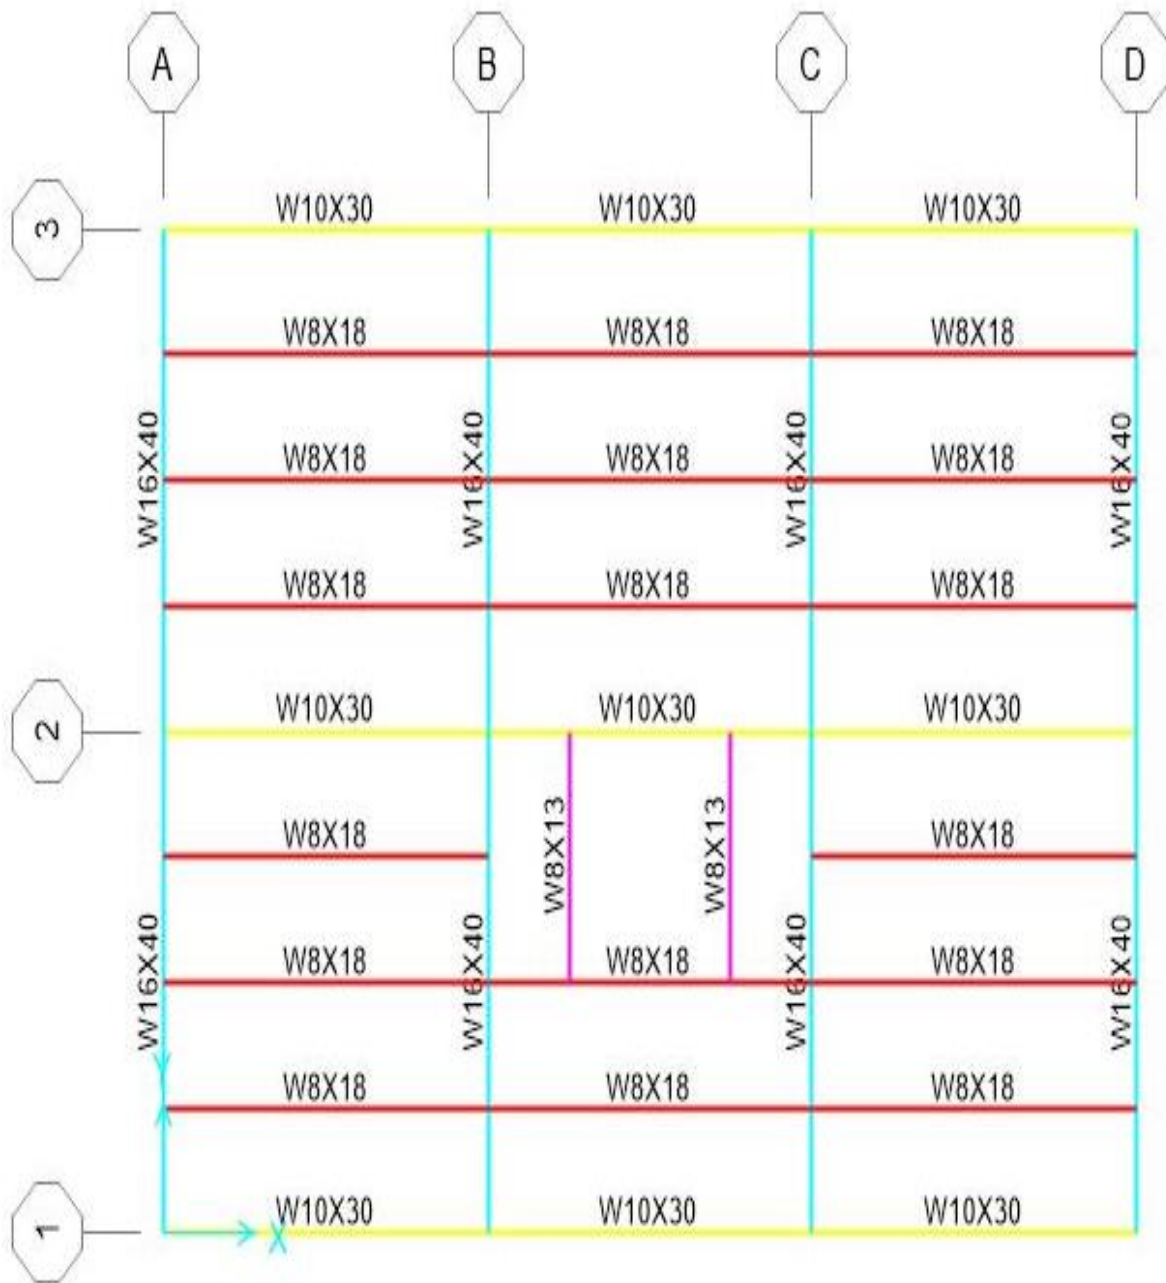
11 Planta estructural Nivel N1, N2, N3 Y N4 (Fuente Propia).
